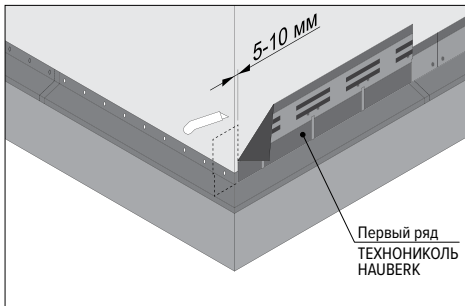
Монтаж второго и последующих рядов фасадной плитки
